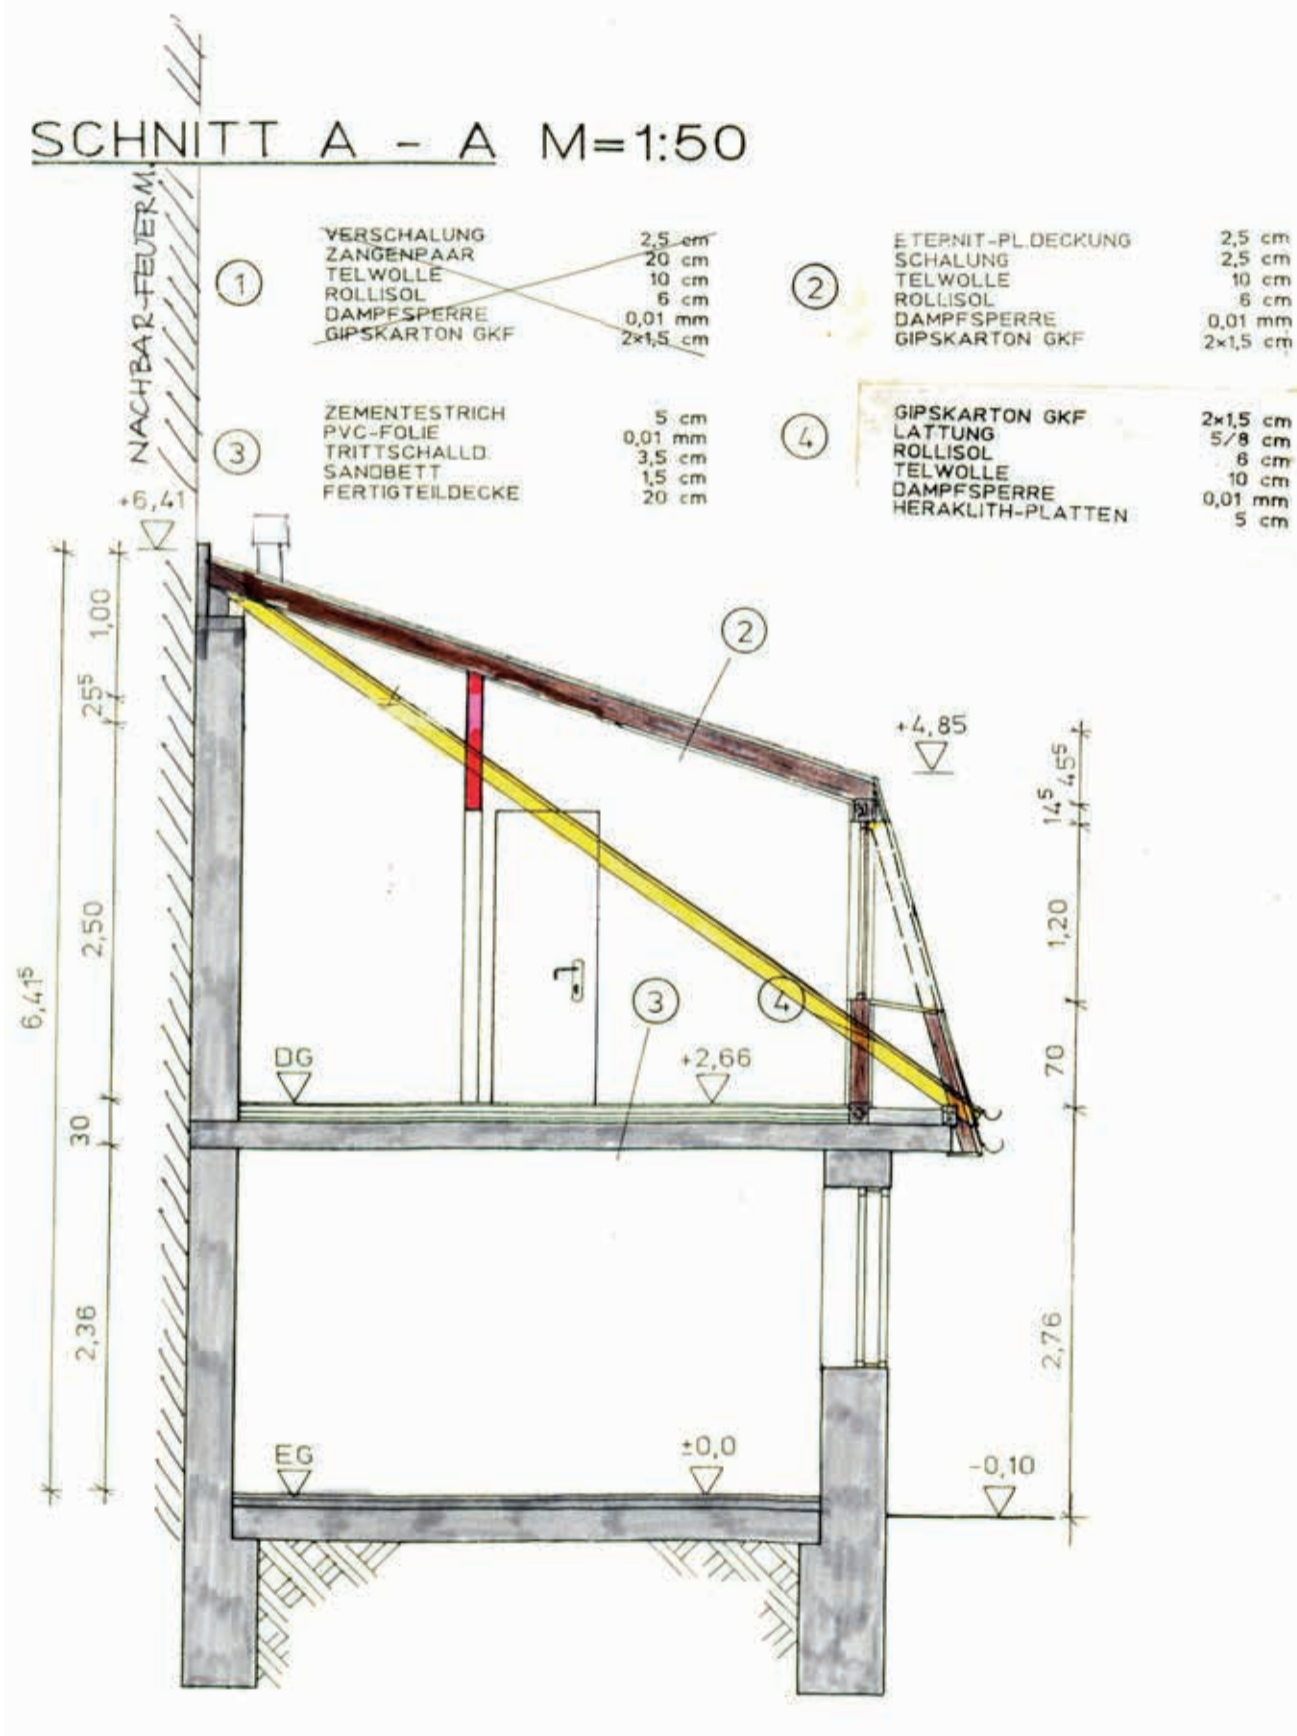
Einreichplan | Schnitt | M 1:50 | 1993
